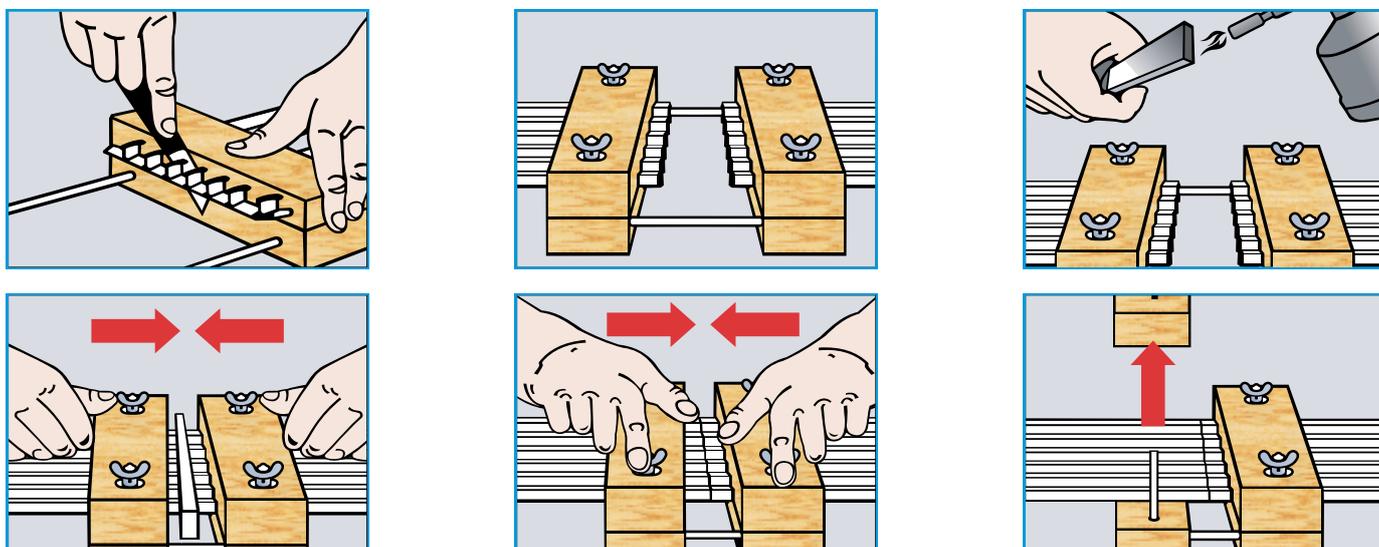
Технологическая схема сварки гидрошпонок
